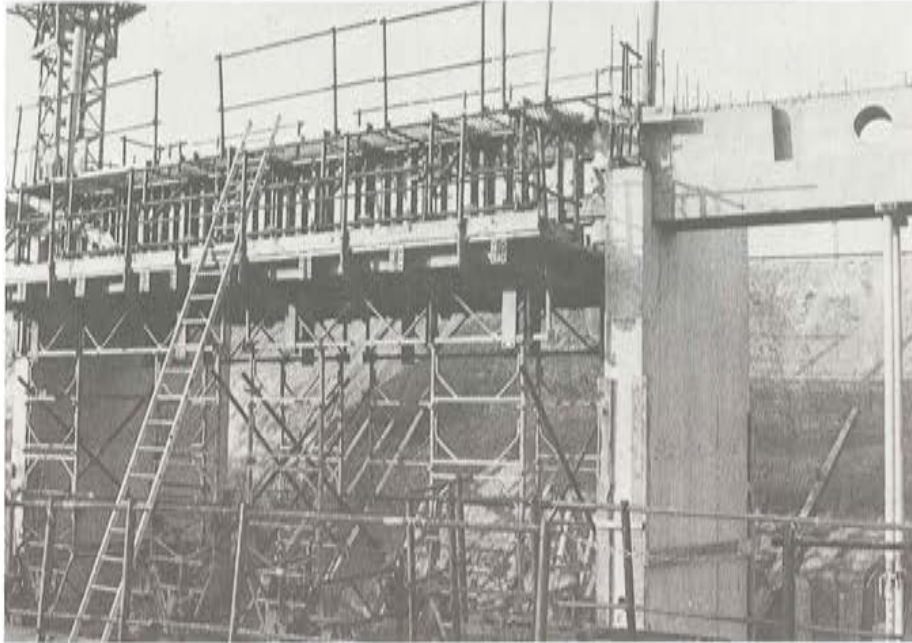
Hormigonado de una viga de los módulos de entrada. (Foto Aéroport de París).
